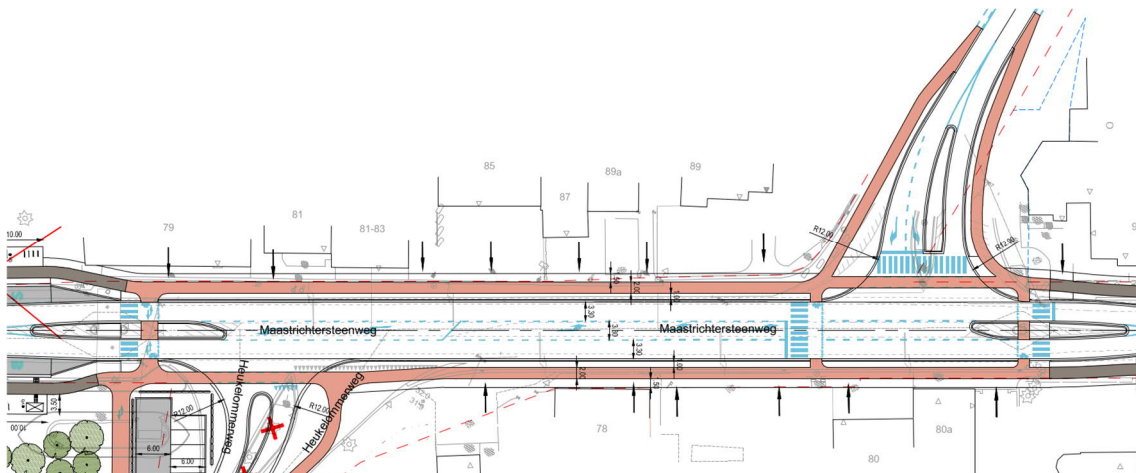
Voorontwerpplan oversteek voetgangers in voorrang/fietsers uit voorrang
